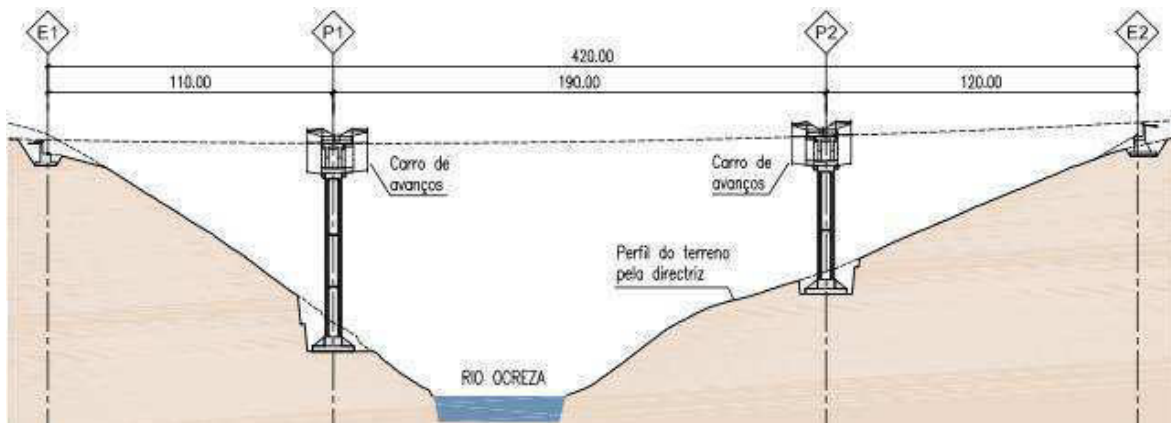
PROC – Faseamento Construtivo – Fase 3 [8]
